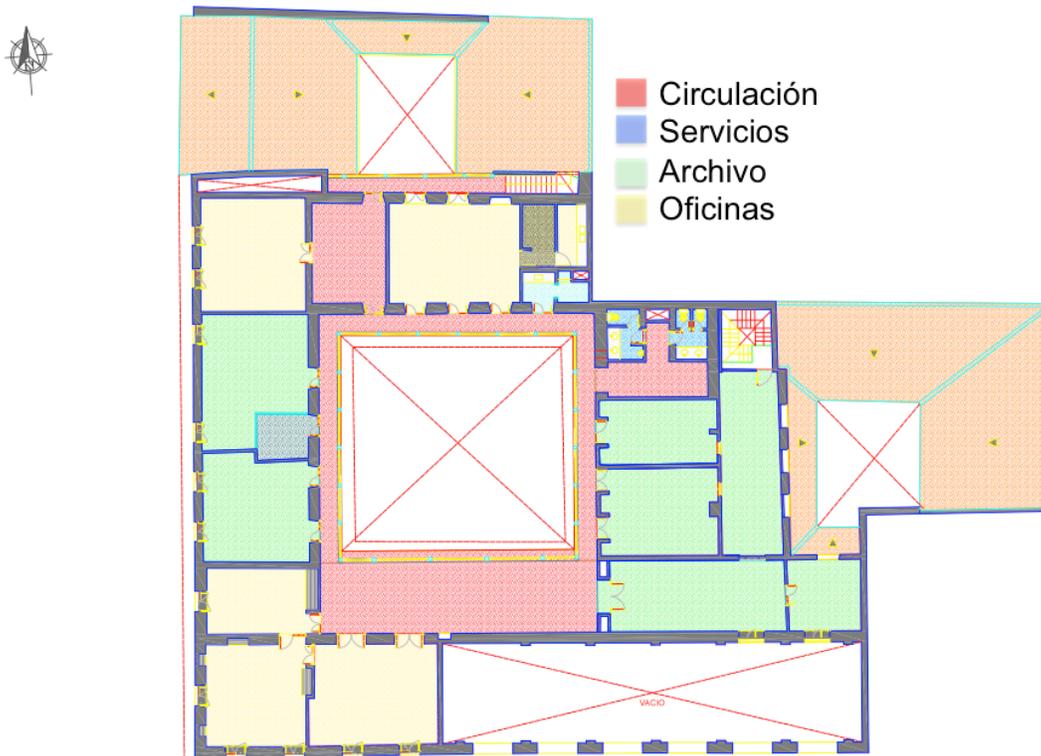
Planos de Uso Actual, Planta de tercer piso. MGC 2014 Ref.
